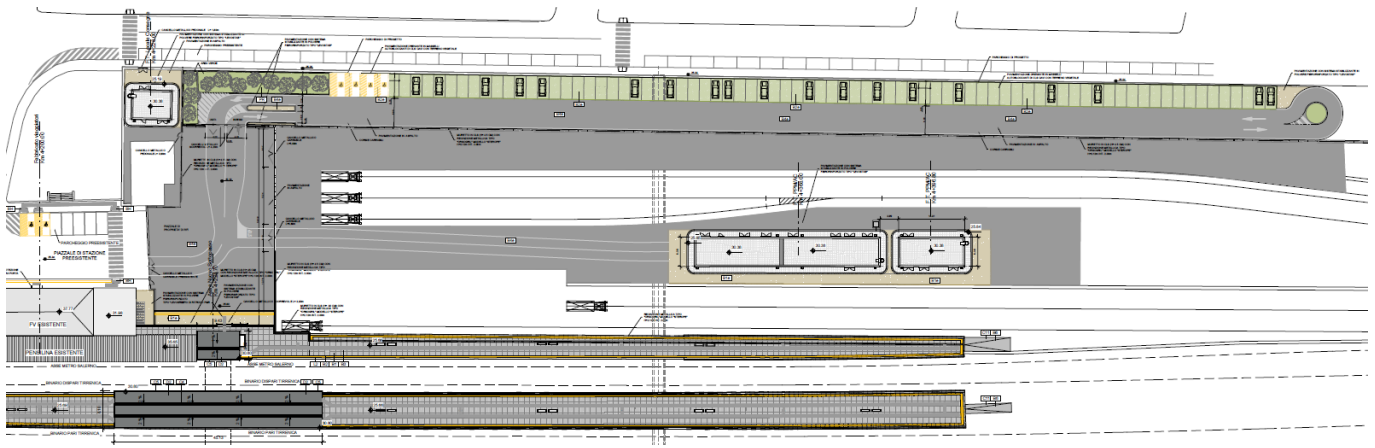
Stazione di Pontecagnano – Planimetria generale
